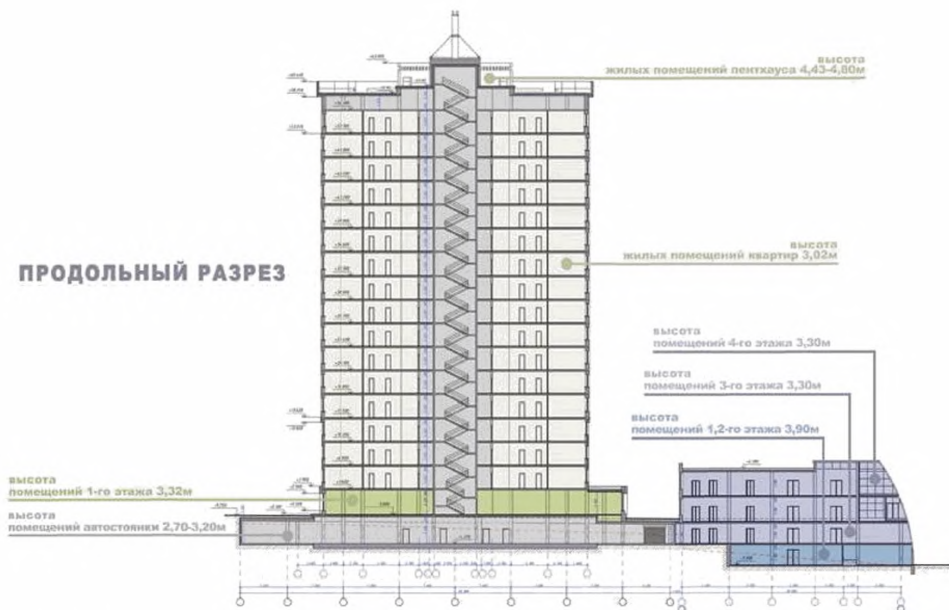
Устройство нежилого этажа над стоянкой в многоэтажном жилом доме
